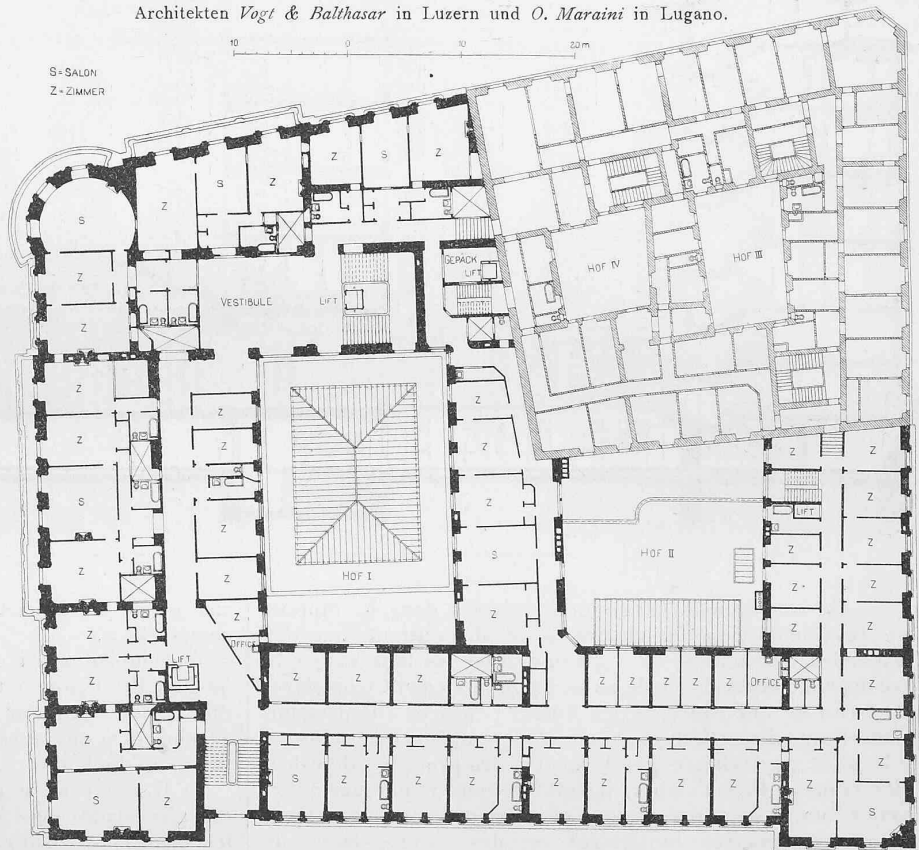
Grundriss vom ersten bis vierten Obergeschoss. — Masstab 1 : 600.
